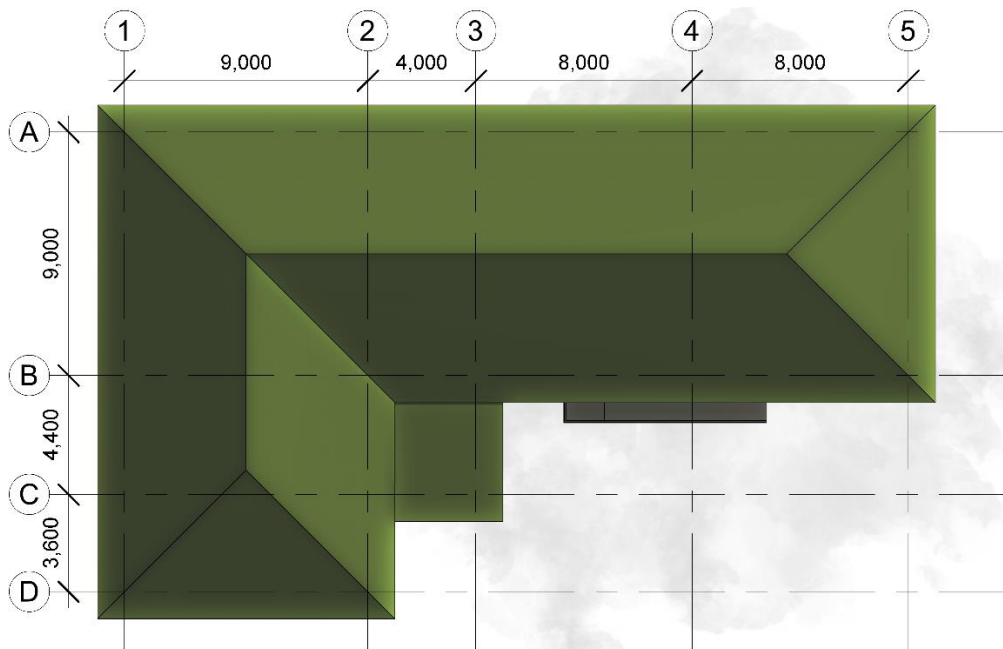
PLANTA DE TECHO EDIFICIO 4 | Elaborado por: El autor
